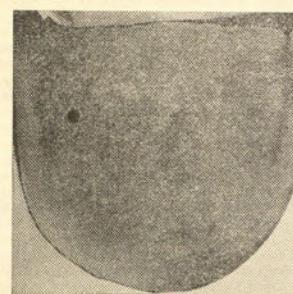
Макрошлиф поперечного сечения горизонтального стыка, сваренного ванным способом; диаметр стержней 80 мм
